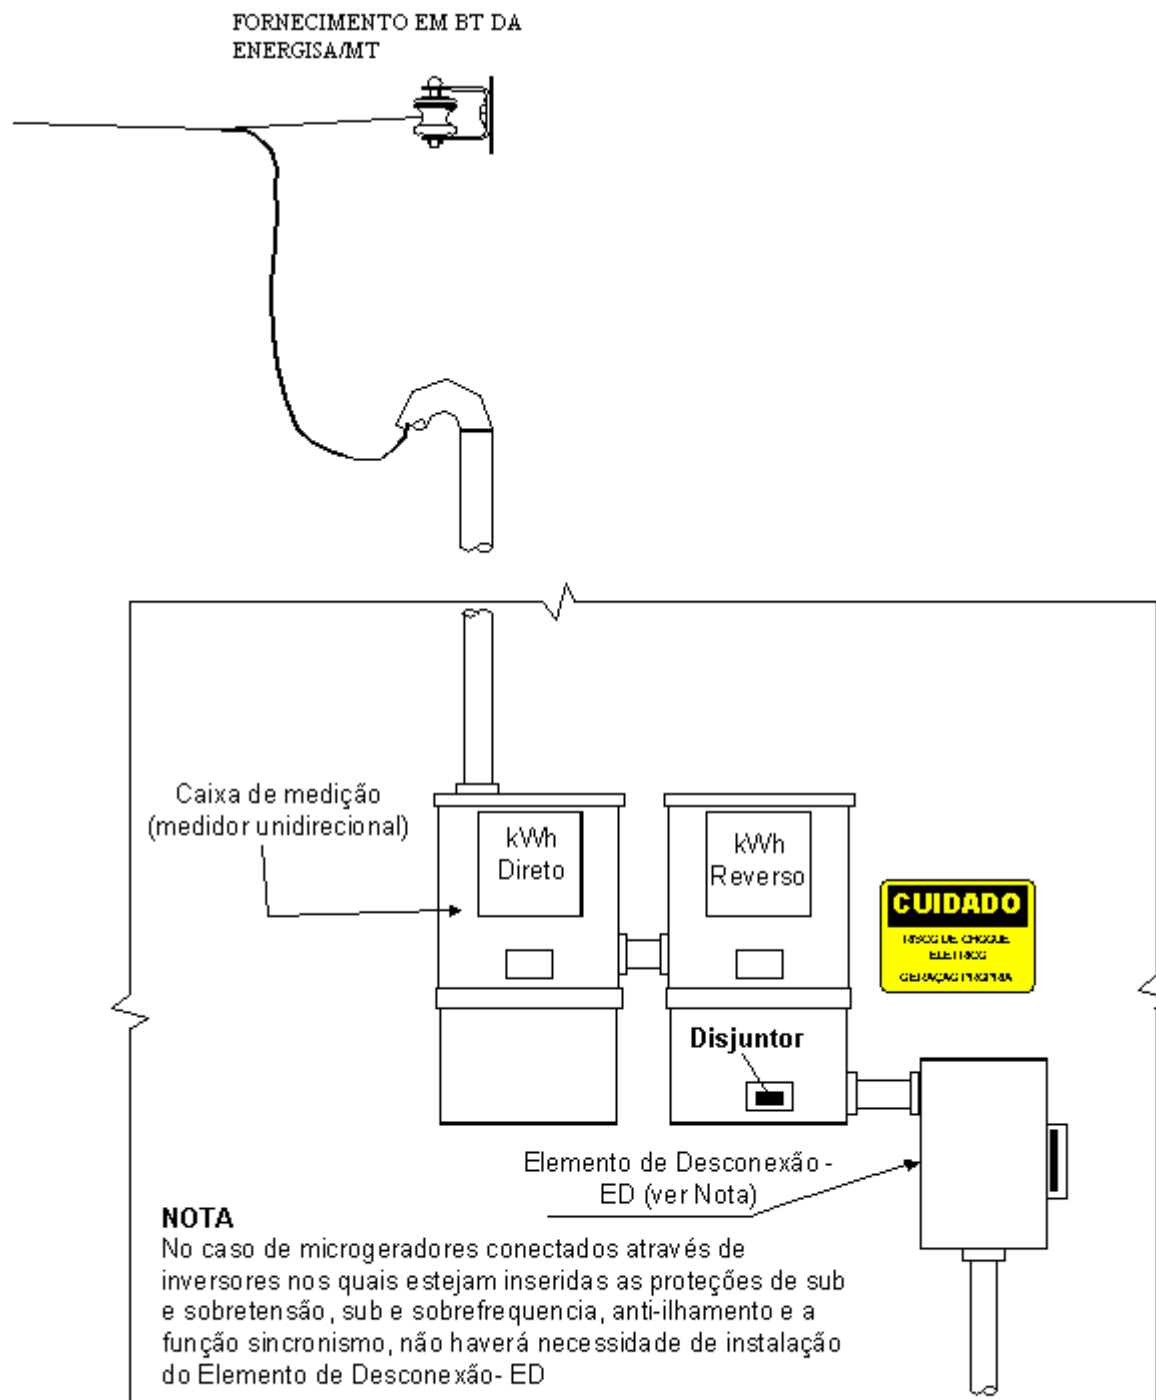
Disposição do Elemento de Desconexão - ED - instalado junto à medição e proteção no padrão de entrada em muro ou mureta - com dois medidores unidirecionais
